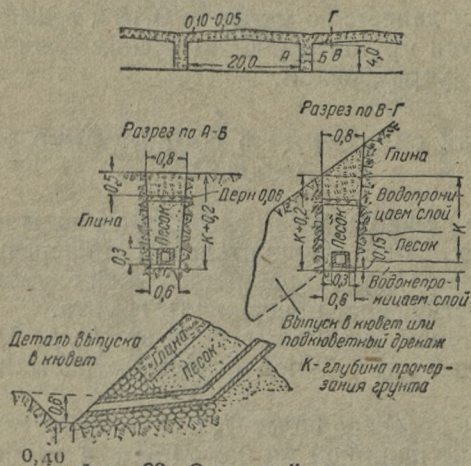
Отвод грунтовых вод от выемки продольным надоткосным дренажем
